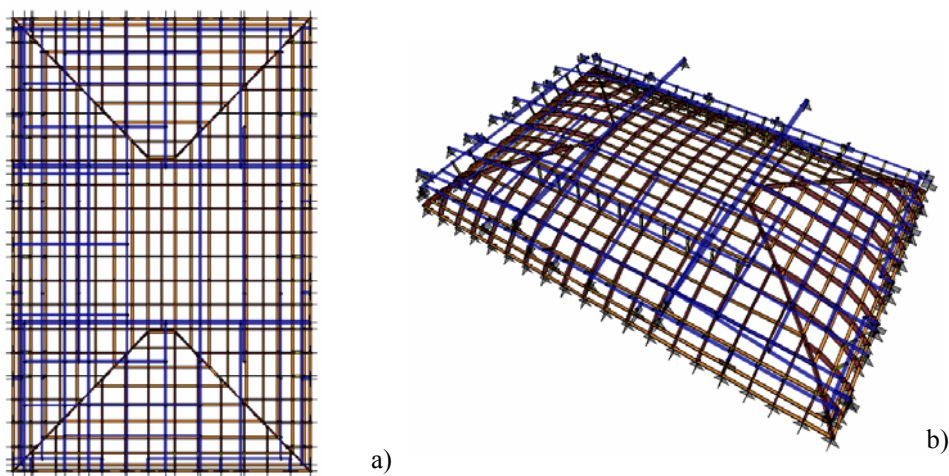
Modello strutturale della volta: a) Vista in pianta; b) Vista 3D.
